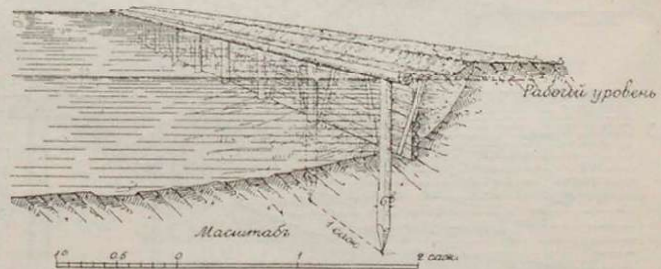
Типъ № 5. Укрѣпленіе подошвы надводнаго откоса пластинными щитами.
